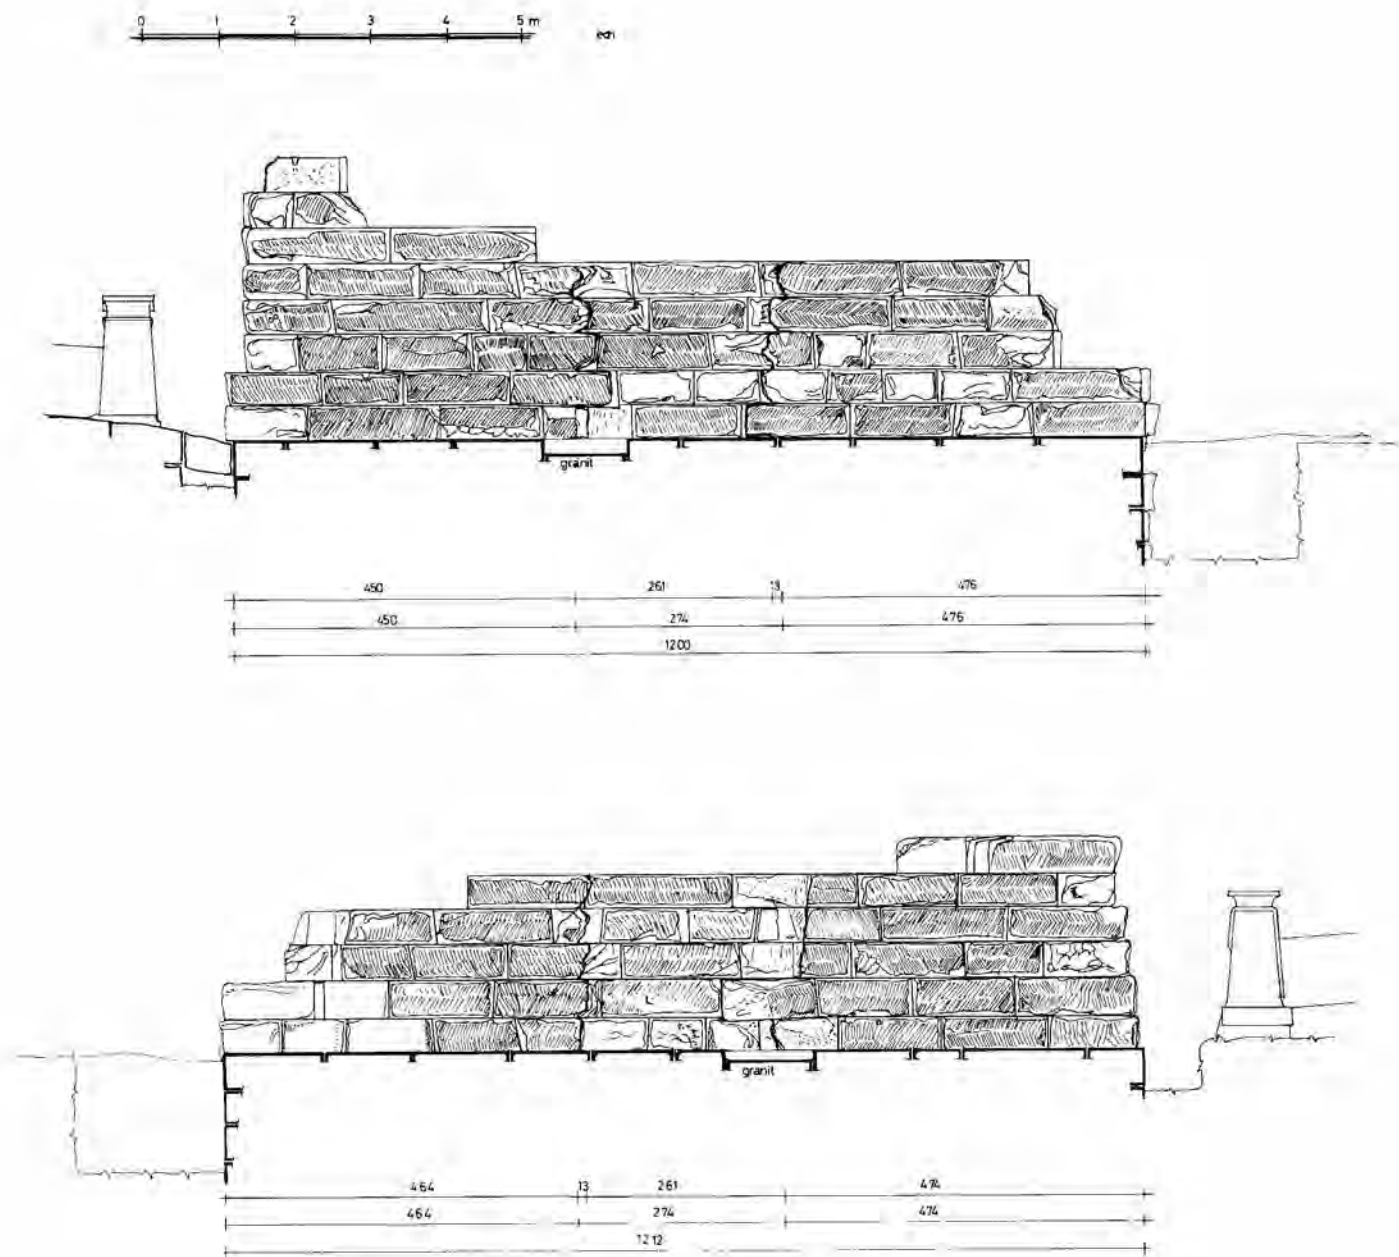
Porte P : coupes et élévations intérieures avec amorce de la rampe.
